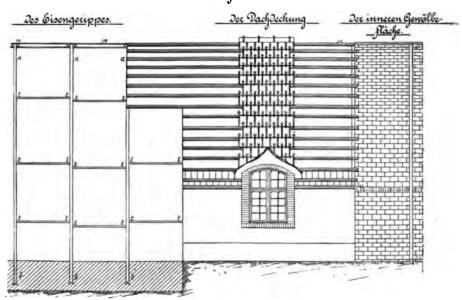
Konstruktionssystem eines Krankenhauses nach Tollet.
